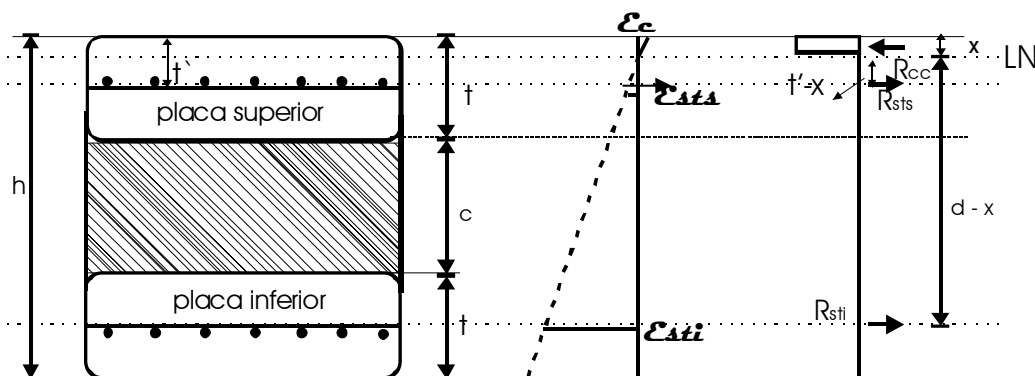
Seção transversal e diagramas de tensão e de deformação para linha neutra acima da armadura.
